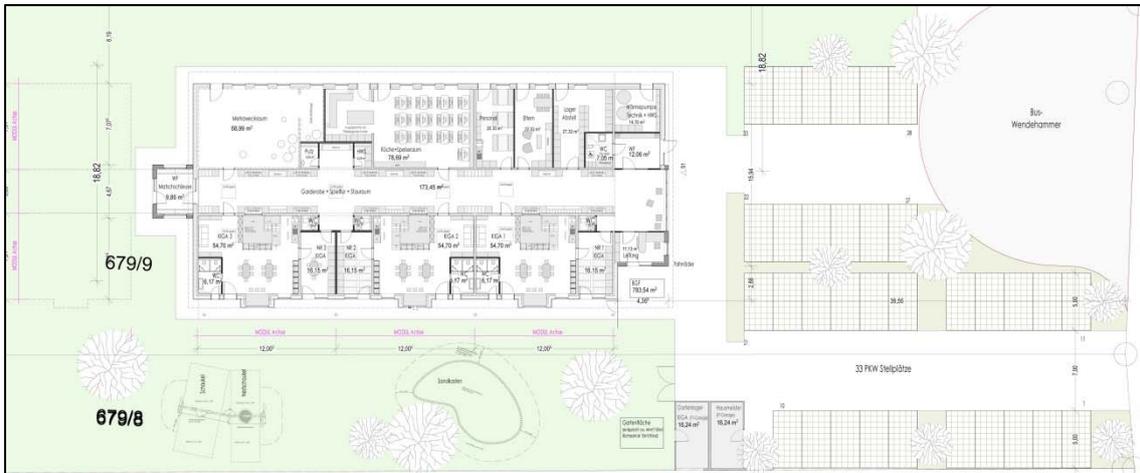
Grundriss des geplanten Kinderhauses
